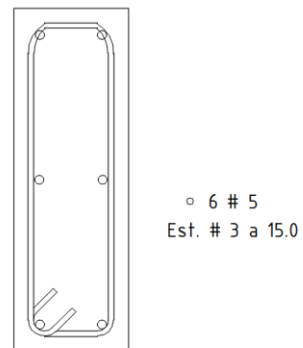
Plano de taller para solera SC - 2, sección transversal
